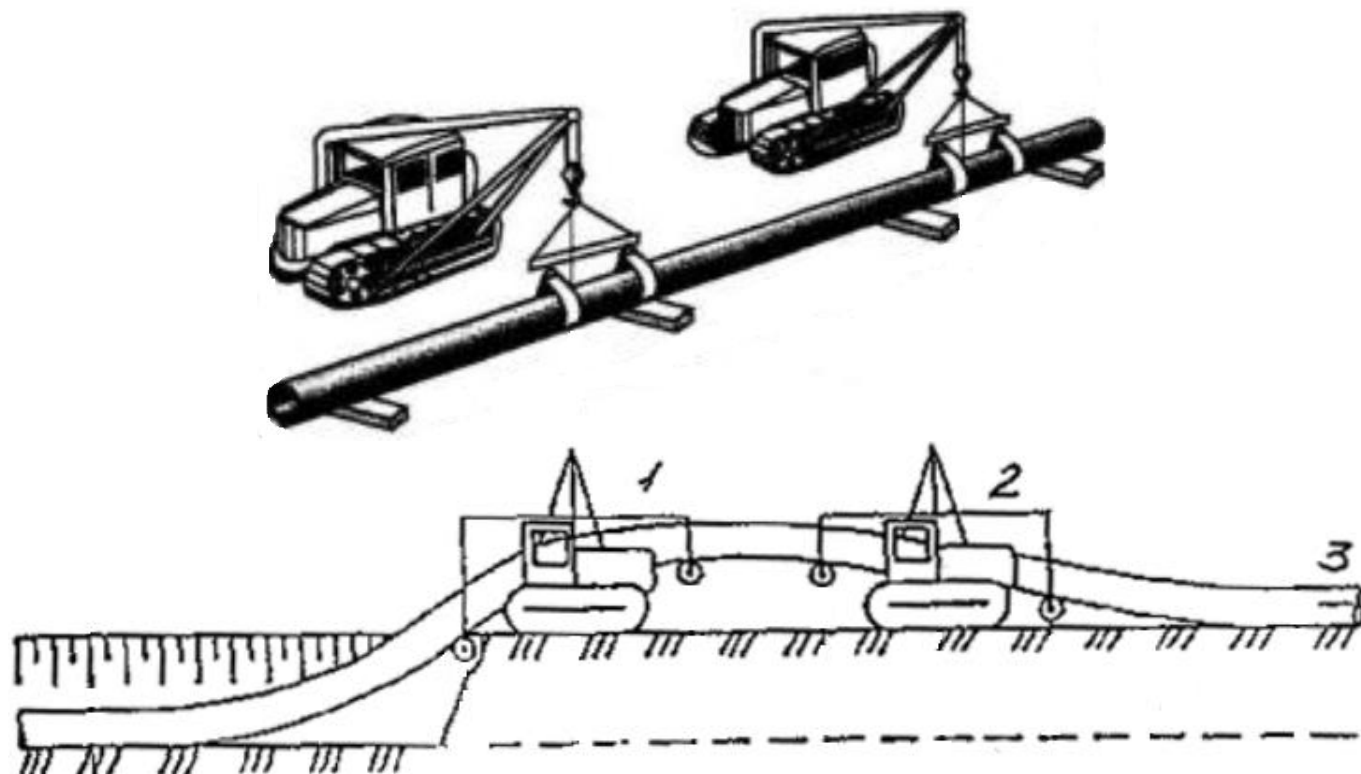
Схема прокладки газопровода диаметром свыше 160 мм отрезками, где 1, 2 – трубоукладчики с траверсами; 3 – трубная плеть
